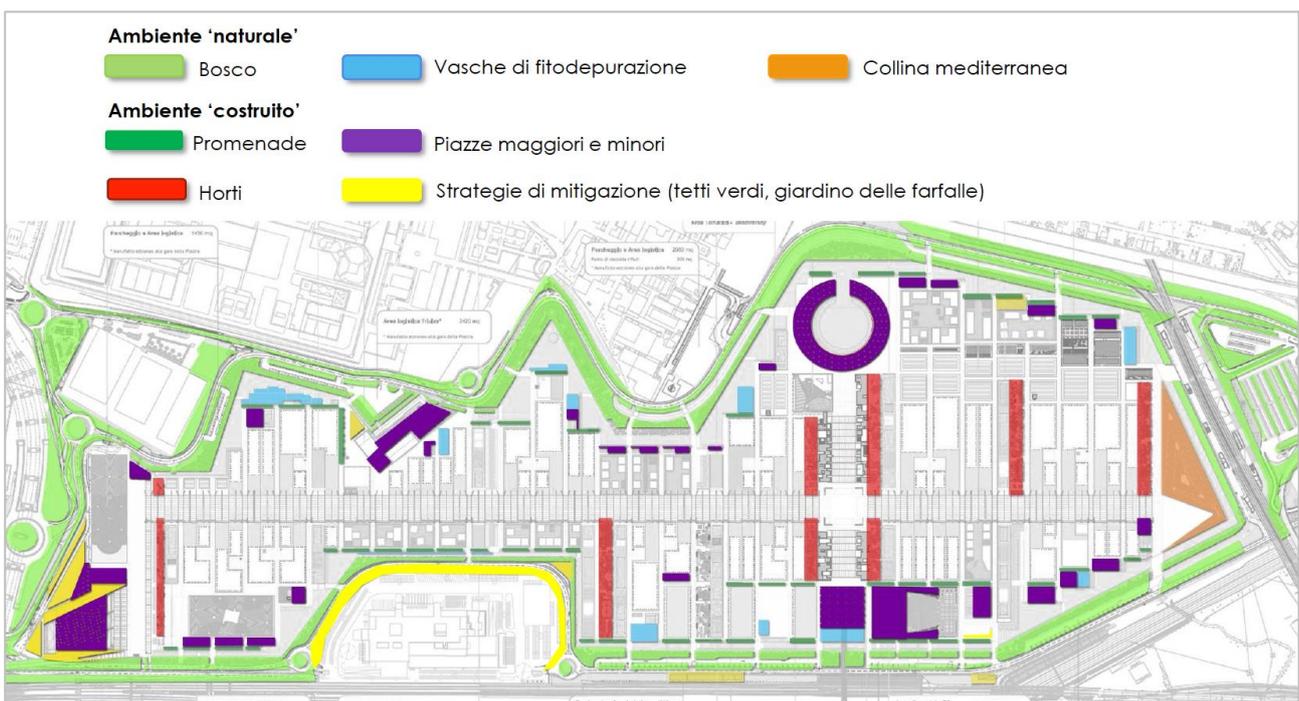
Planimetria indicante la suddivisione delle aree di ambiente "naturale" e "costruito"
